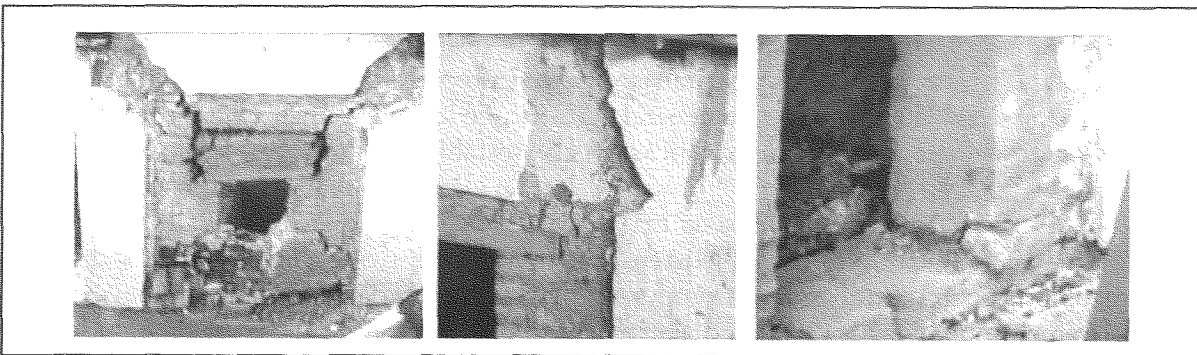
Detalle de grietas principales - Vivienda III
